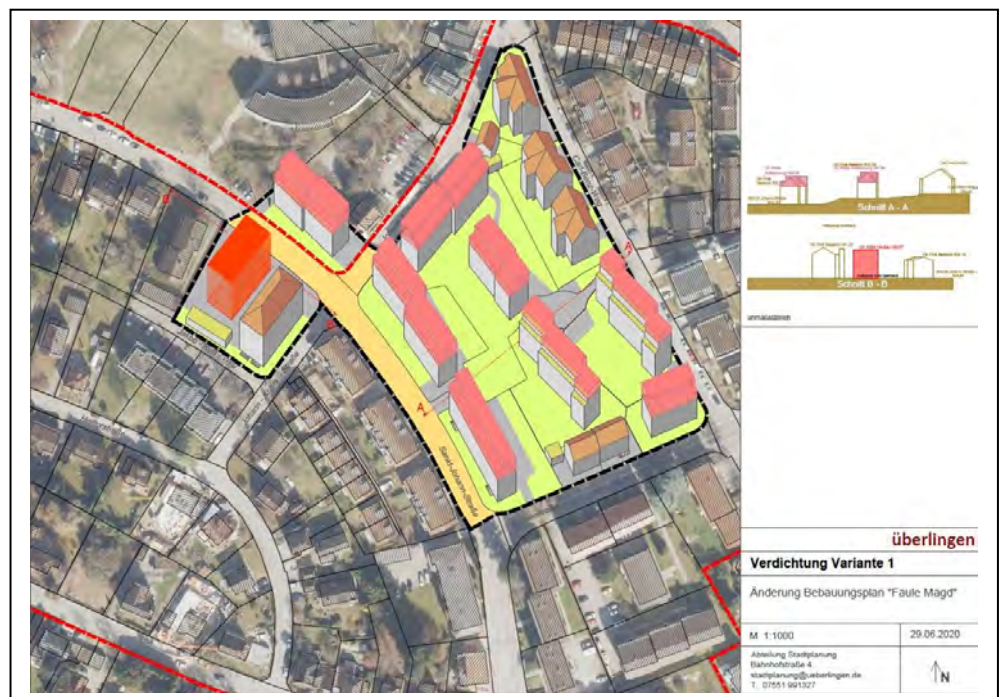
Änderung Bebauungsplan „Faule Magd“ (Variante 1) vom 29.06.2020 (STADT ÜBERLINGEN in lit. 2021)
